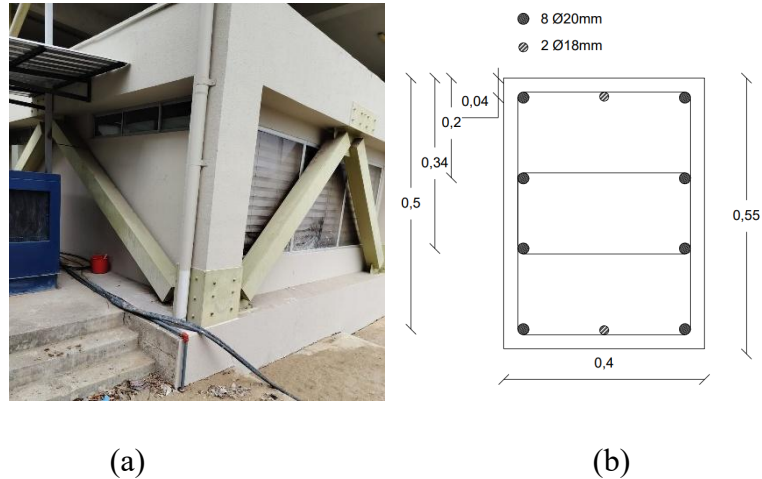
(a) Columna confinada en el eje G1. (b) Sección transversal de la columna
